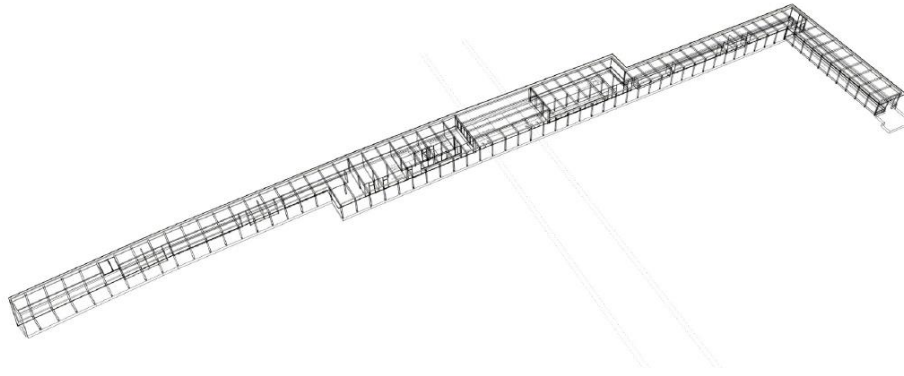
Gebäudestruktur Ersatzneubau Seebad Bürger I
